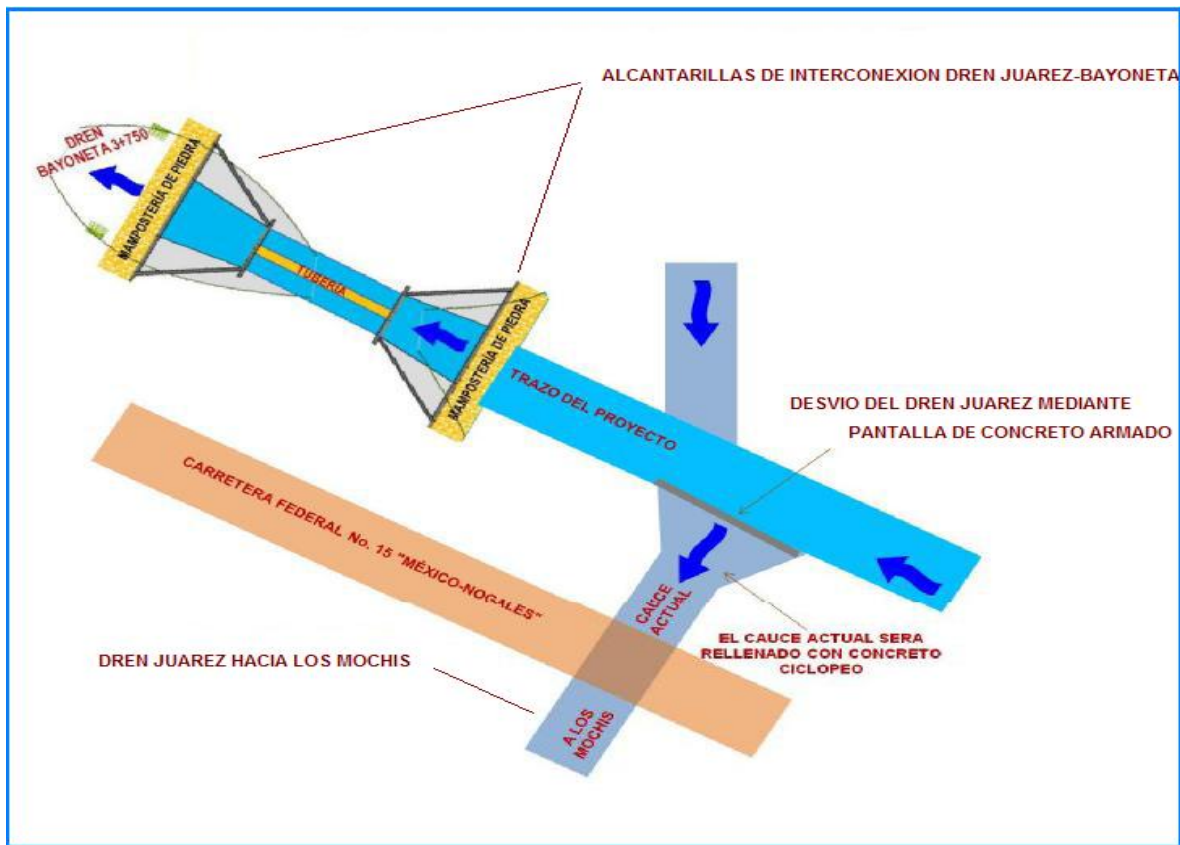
Desvío del dren Juárez hacia Buenaventura vía interconexión dren Bayoneta-Cerrillos, Cerrillos-Buenaventura en cada interconexión se construirán alcantarillas con mampostería de piedra bola para evitar erosión en las conexiones de los drenes.
